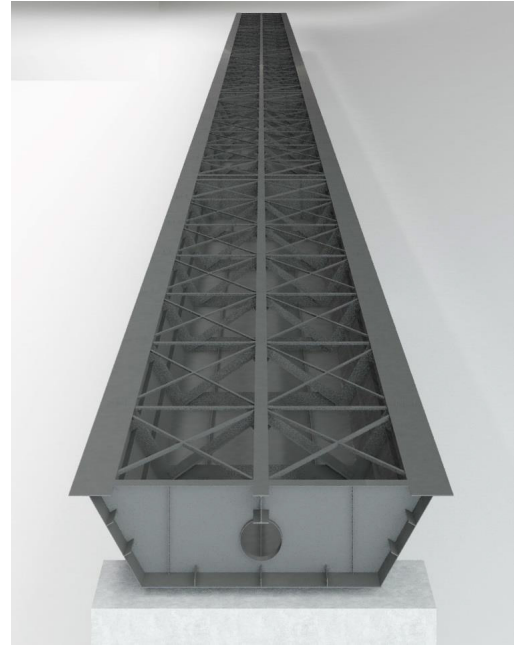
Modello 3D soluzione di trave a cassone con schema a trave continua
